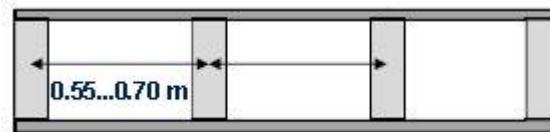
Elemento di solaio a cassone con pannellatura incollata sui due lati [4]
